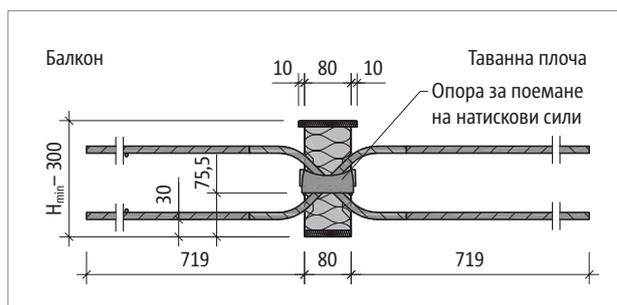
Schöck Isokorb® T mun QL-VV1: Сечение на продукта
